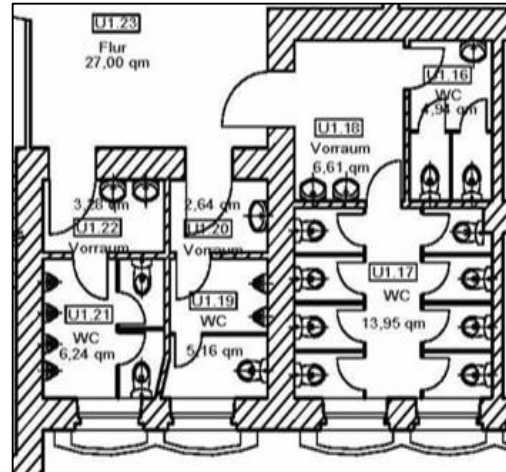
| Grundriss Kellergeschoss Georg-Löck Haus
